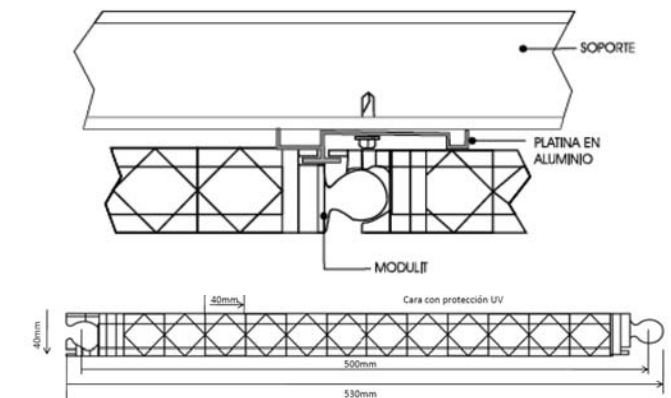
Detalle constructivo del sistema MODULIT de policarbonato para fachadas. Fuente: Arkos Ecuador S.A.
